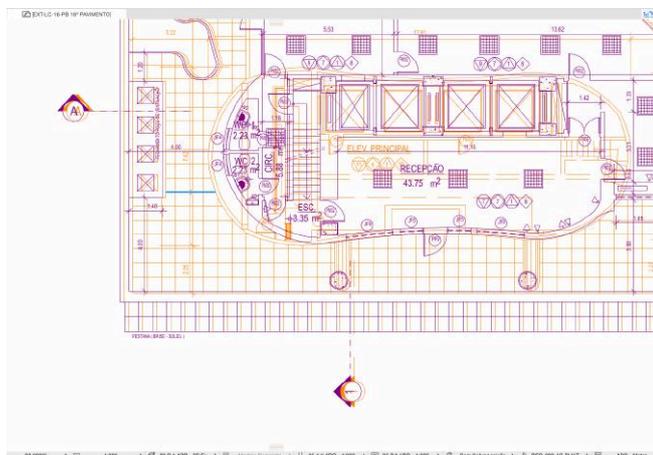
Incompatibilidade no posicionamento dos Pilares – Pavimento térreo, em roxo (Hall Privativo) e 1º Pavimento em laranja (Camarim)
